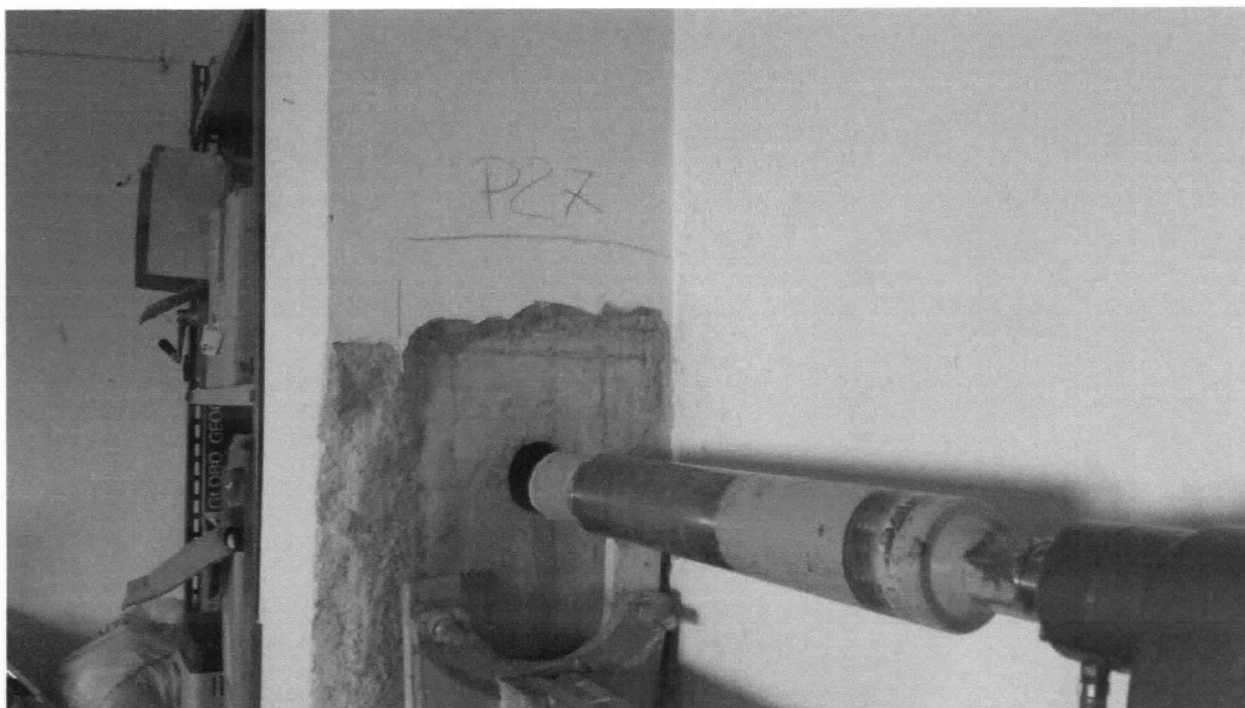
Estrazione di carota di calcestruzzo indurito da pilastro P27
